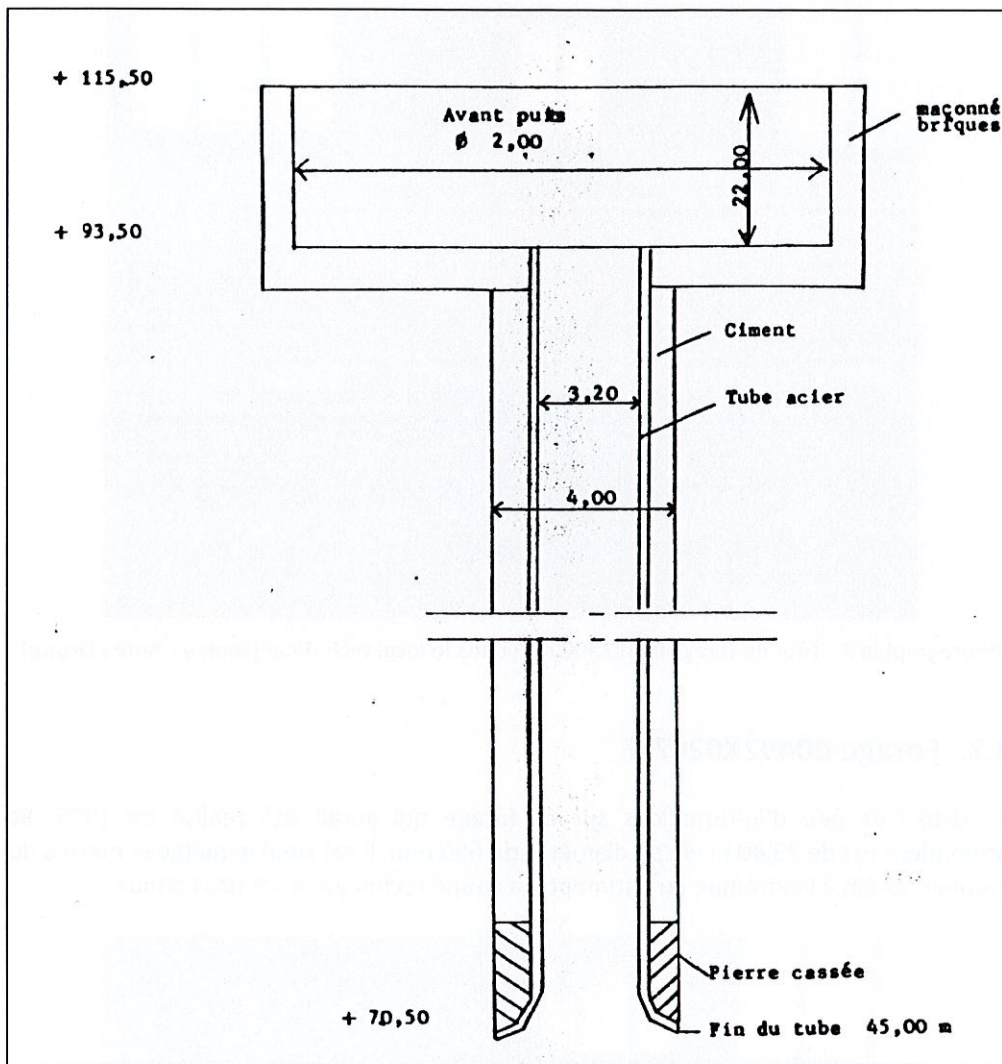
Coupe technique du forage 00492X0001/F (source : infoterre)
